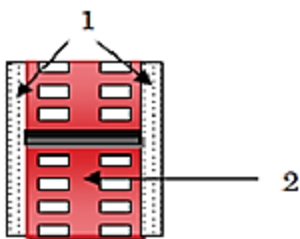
Coupe verticale d'un mur extérieur.
